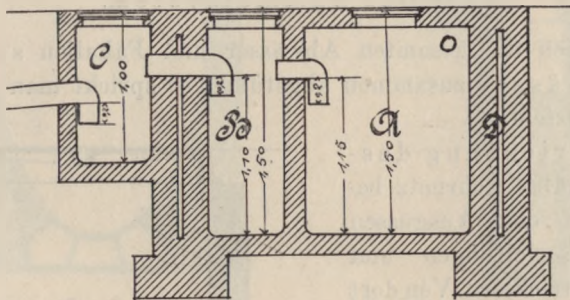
Spülgrube. A erste Grube; B Grube für das schon geklärte Wasser; C Revisionsschacht mit Abfluss zum Kanal; D in dem Mauerwerk eingeschlossene Tonschicht.
